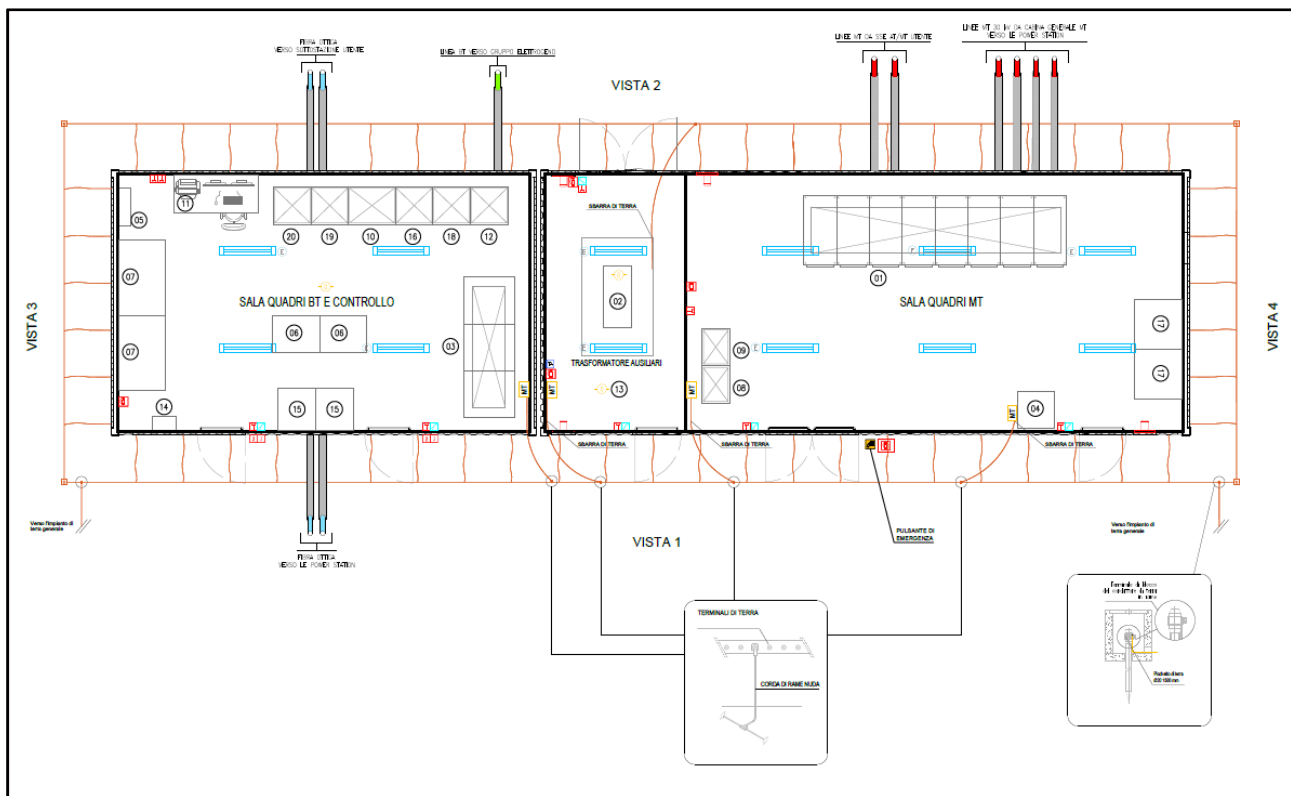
Cabina elettrica e di smistamento – Pianta
